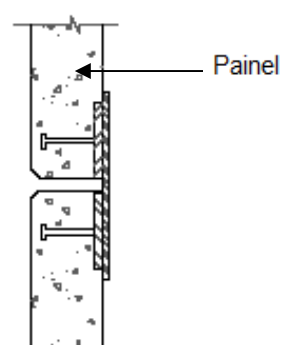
Corte horizontal de ligação macho soldada (Adaptada do PCI, 1989)
